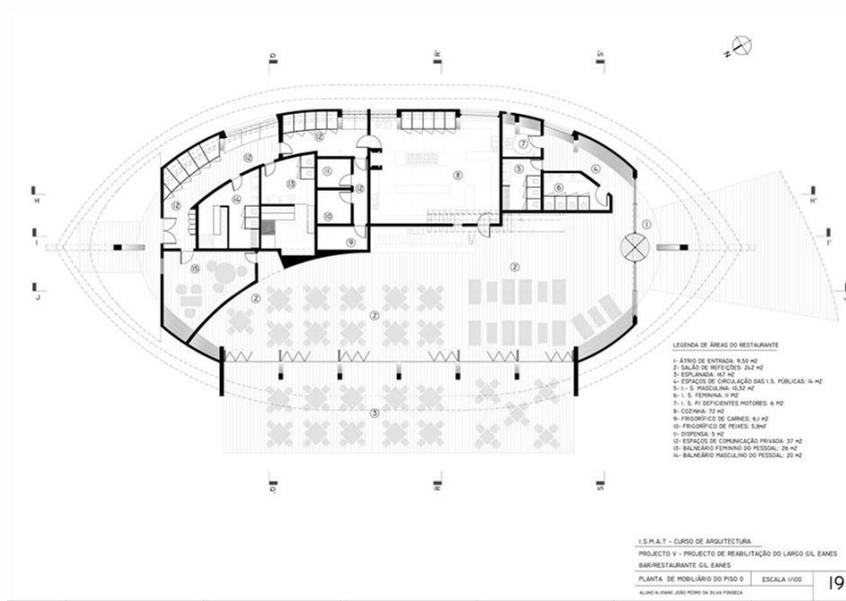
Planta do rés-do-chão do Bar-Restaurante
